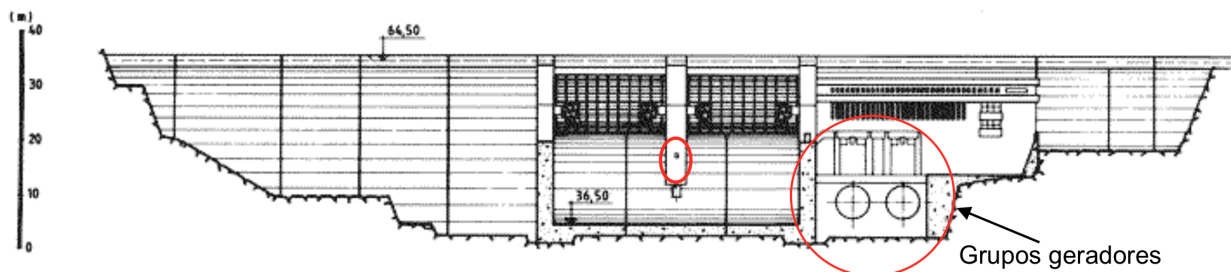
Barragem da Raiva. Vista de jusante. Adaptado de (cnpqb.apambiente.pt).
